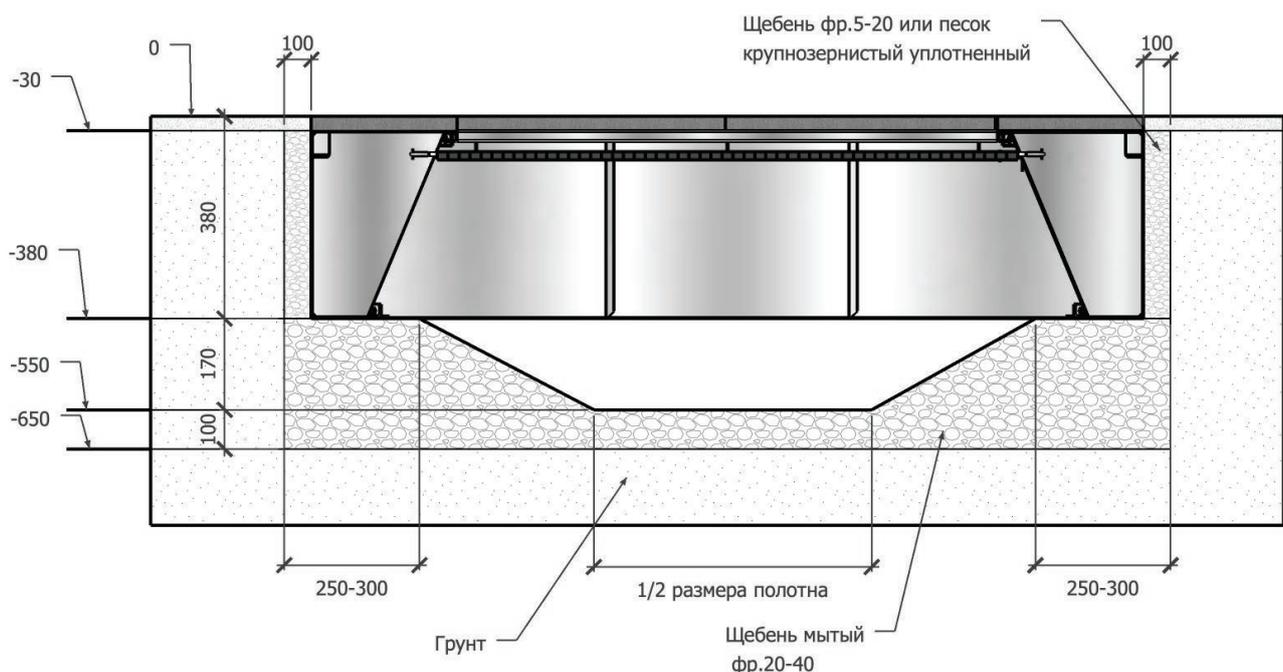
Схема монтажа для I-II зон снеговой нагрузки.
